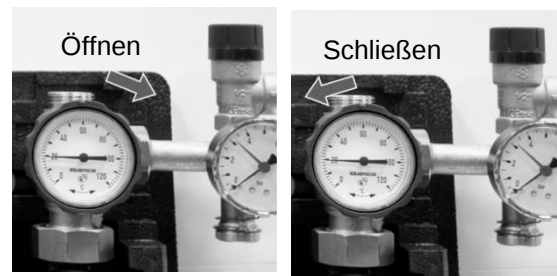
Rücklauf-Kugelhahn kurz öffnen, wieder schließen
